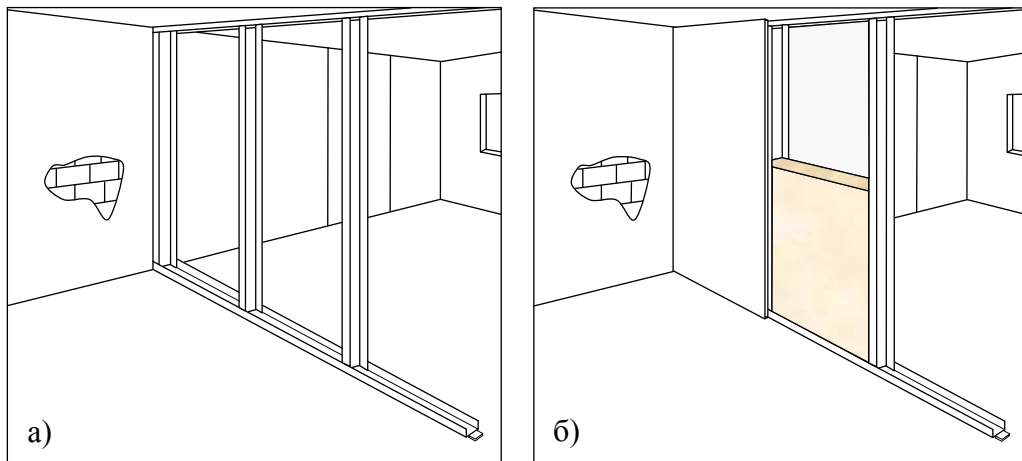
Монтаж гіпсокартонних плит на металевий каркас перегородки:
